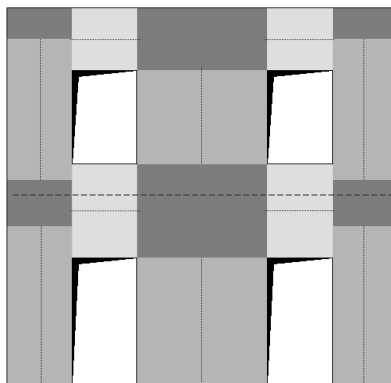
Modellazione a "telaio equivalente" della parete in muratura
